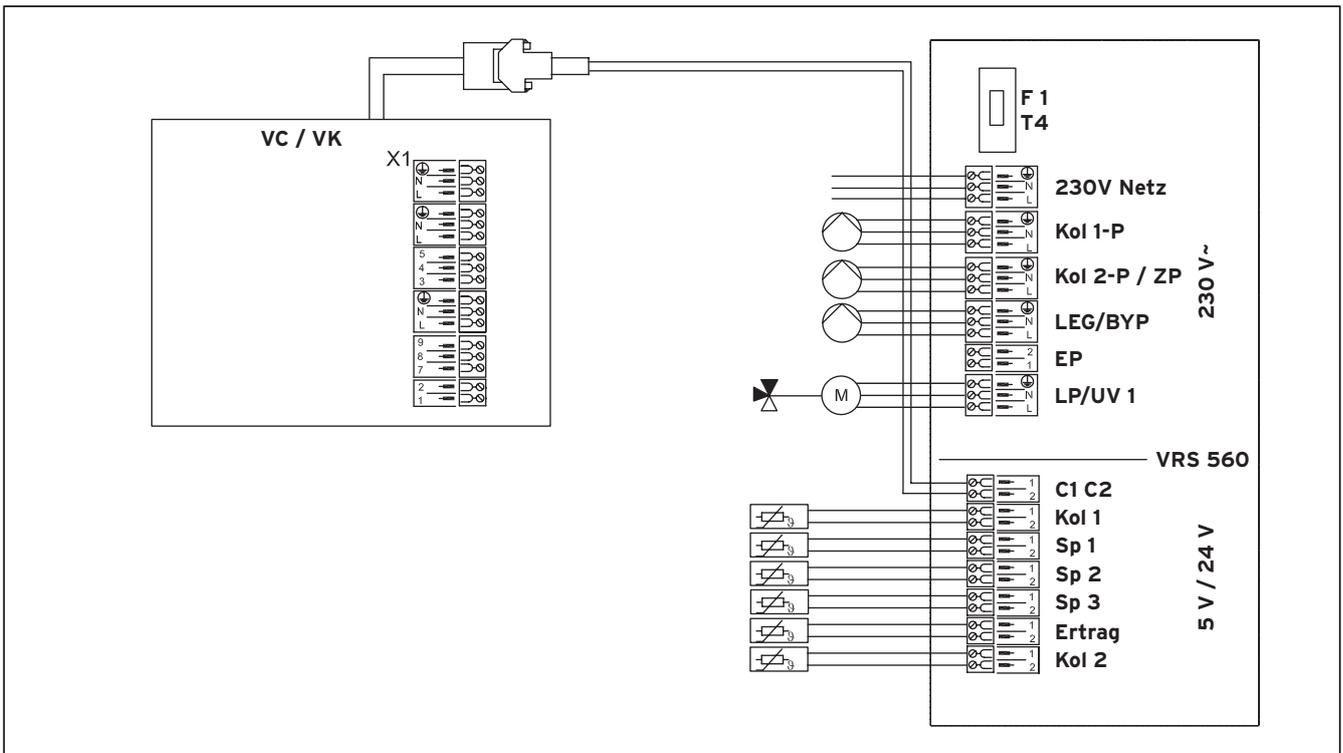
Plan de raccordement pour schéma hydraulique 3
